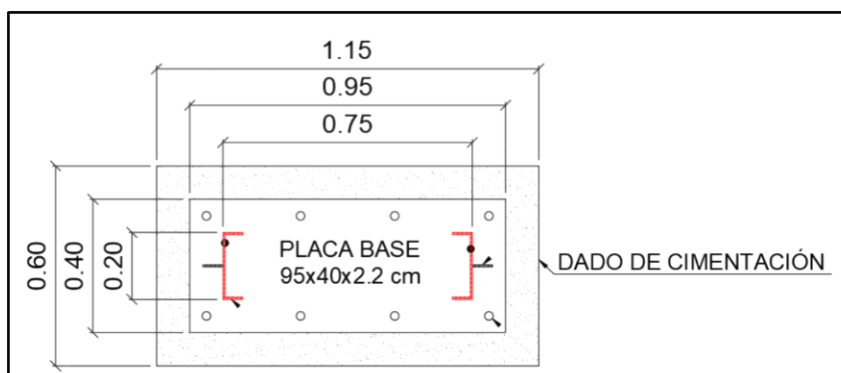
Dimensiones de dado de cimentación, placa base y columna [Pelayo & Ashby, 2020]
